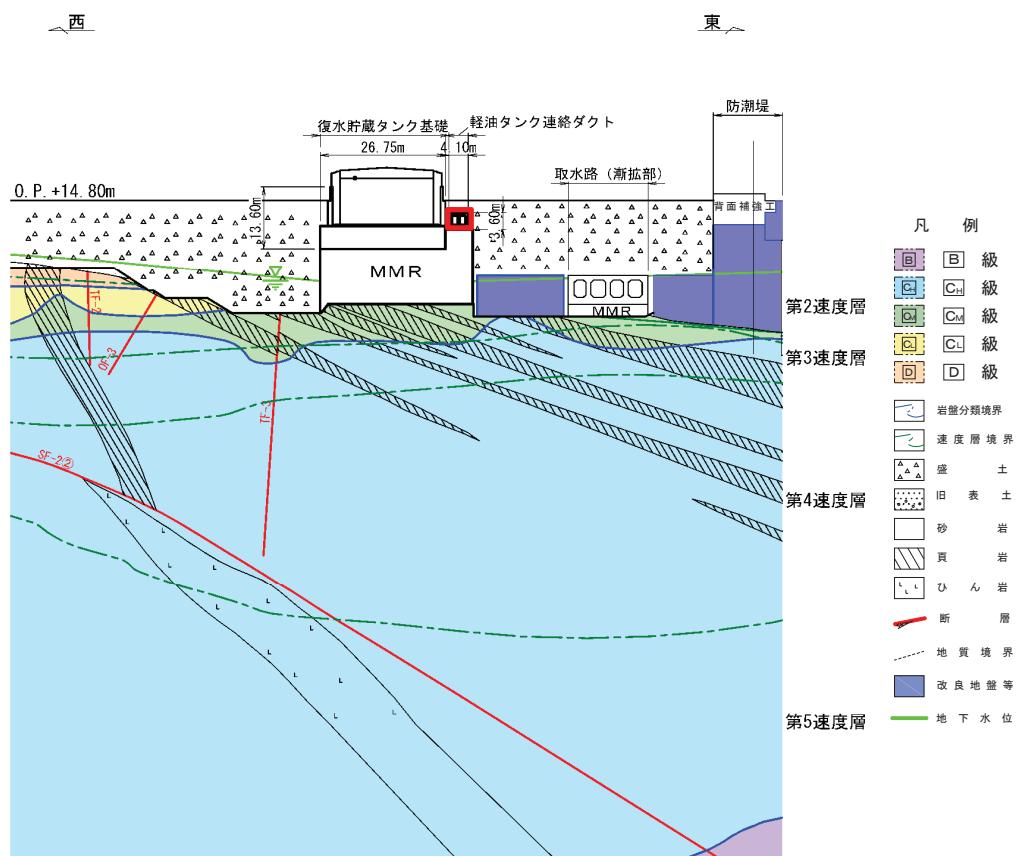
軽油タンク連絡ダクト地質断面図 (B-B)
